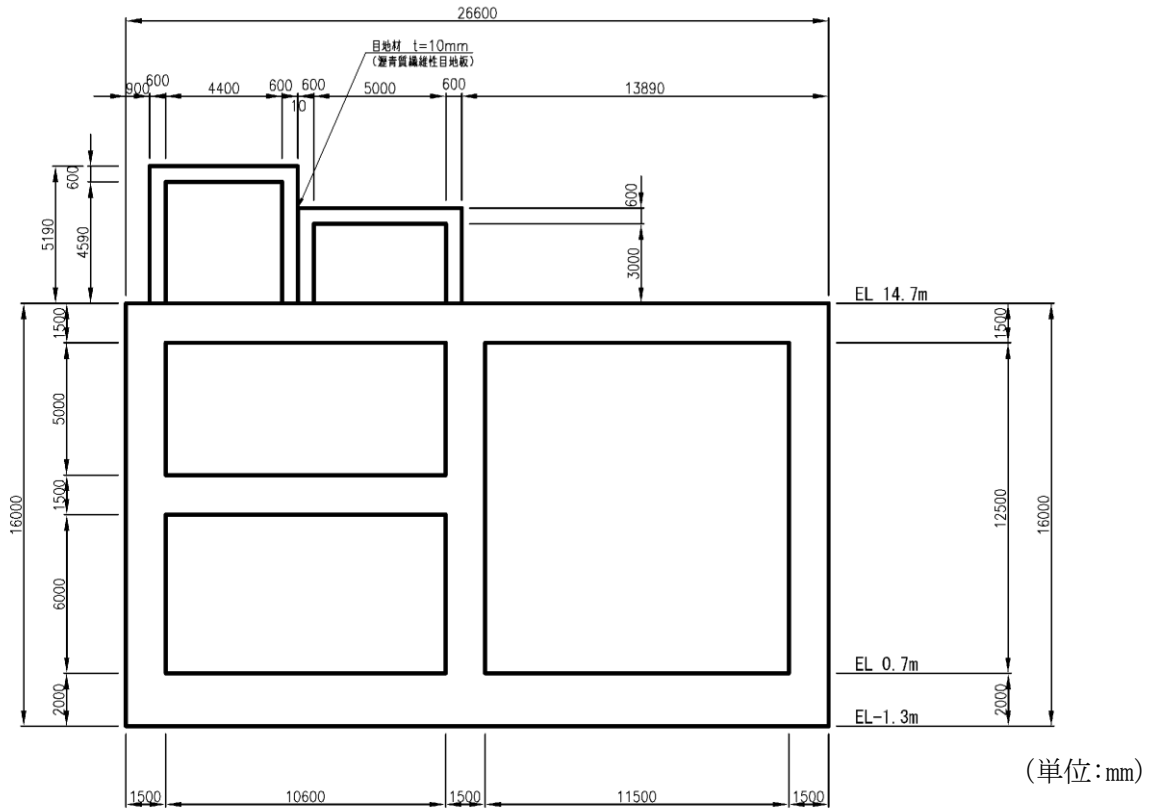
低圧原子炉代替注水ポンプ格納槽 断面図 (C-C断面)
